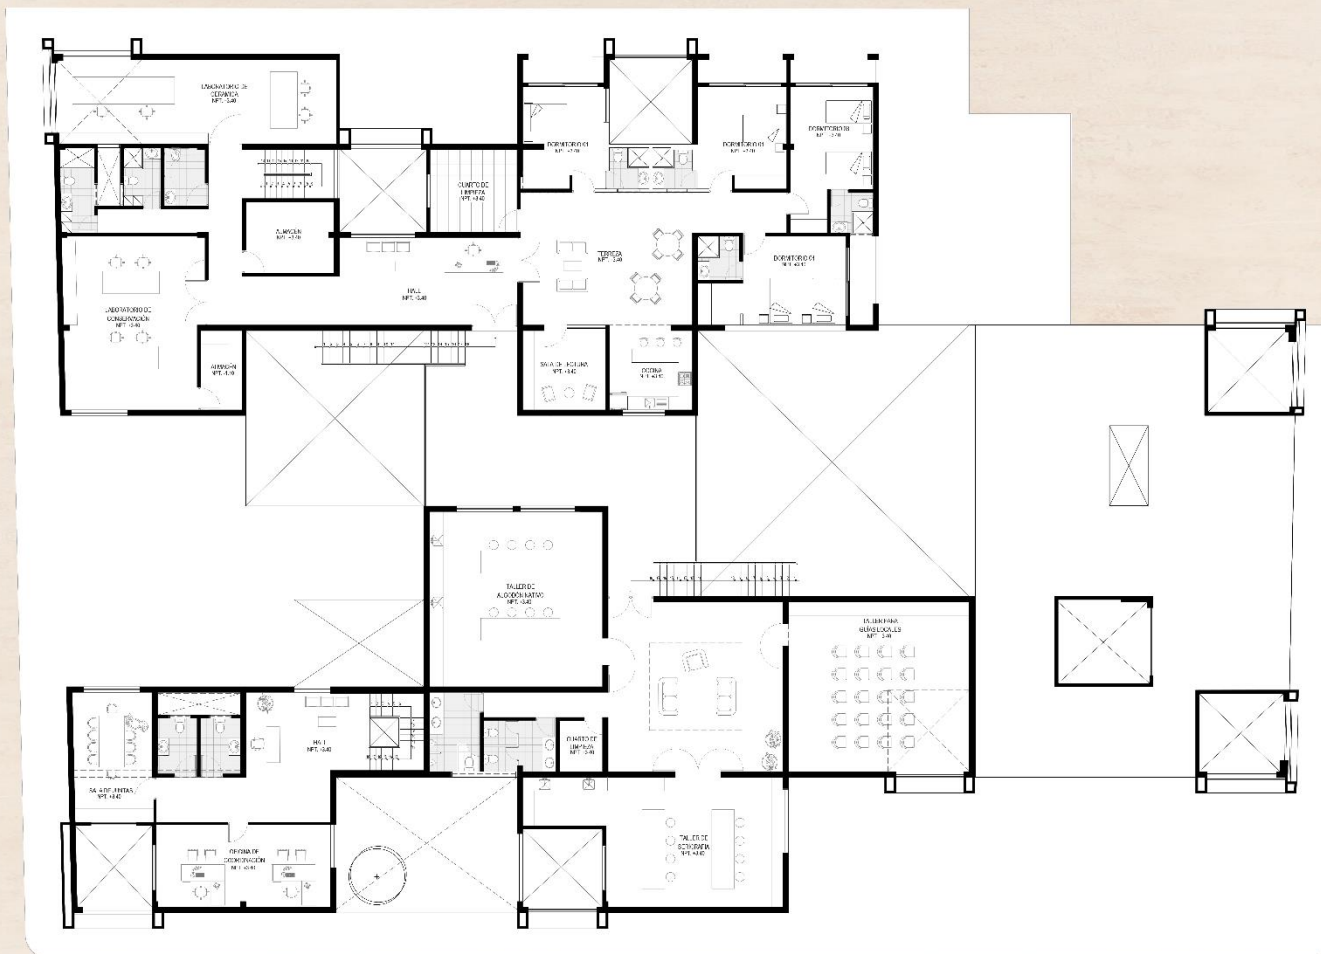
Planta de distribución-primer nivel. Fuente propia
